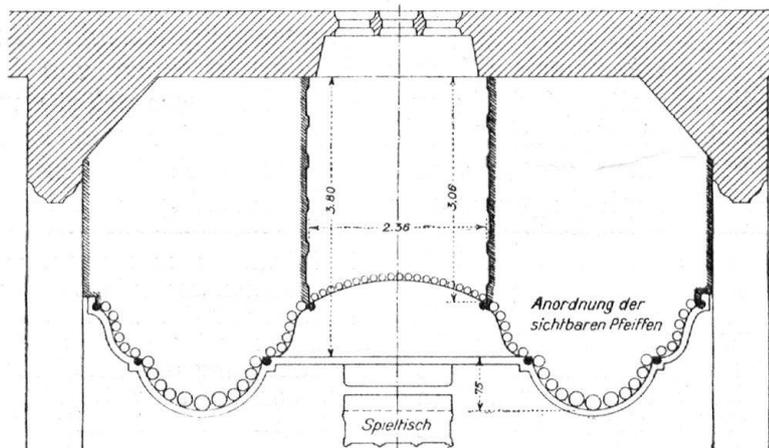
Grundriss zum abgeänderten Entwurf „Friede!“ (1 : 200).
